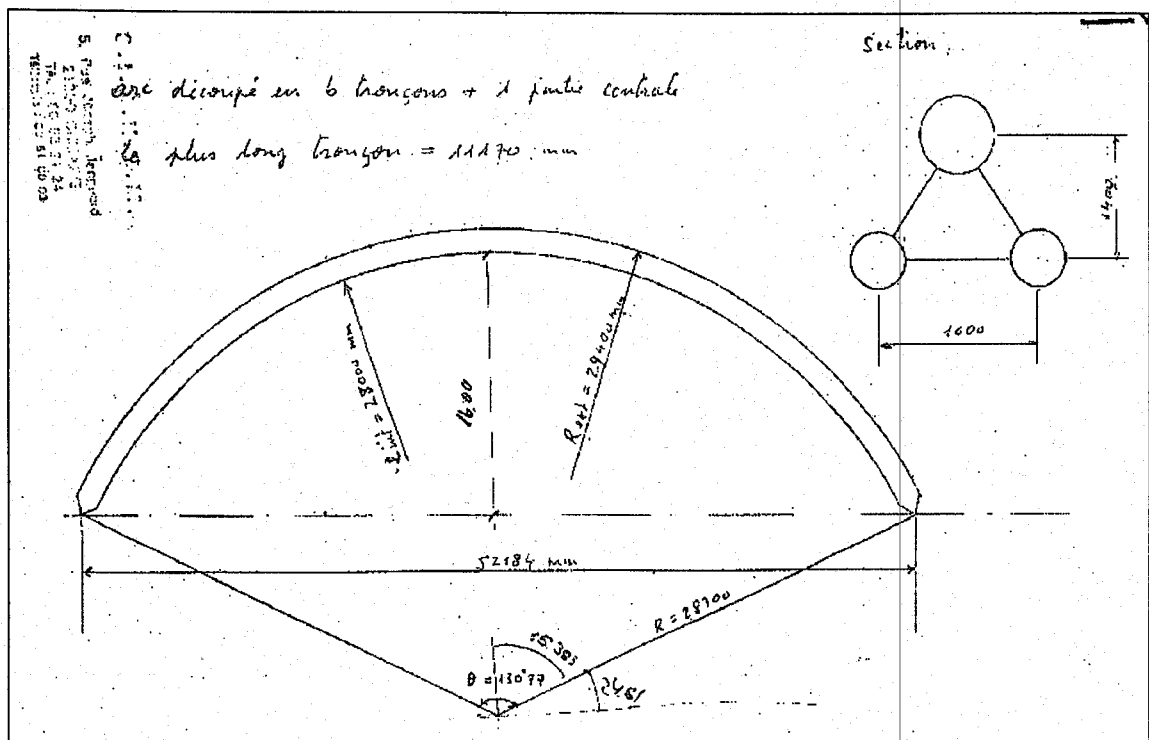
Croquis (alzado) de la estructura. Apeadero del AVE.
